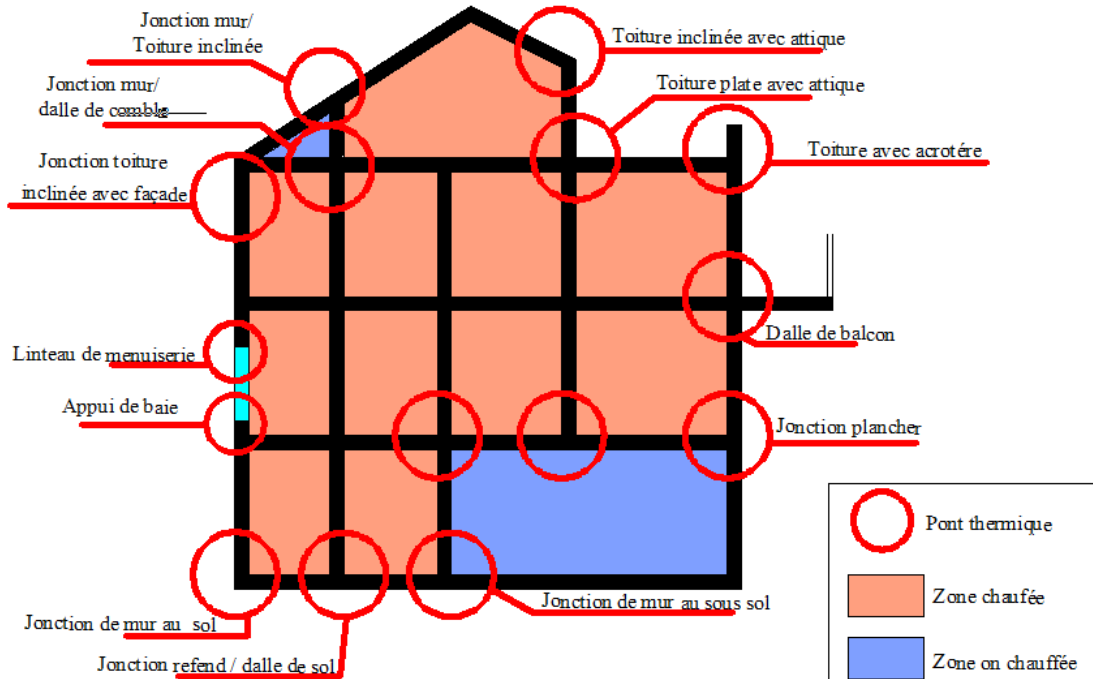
Vue d'une construction coupe verticale ; localisation des ponts thermiques
